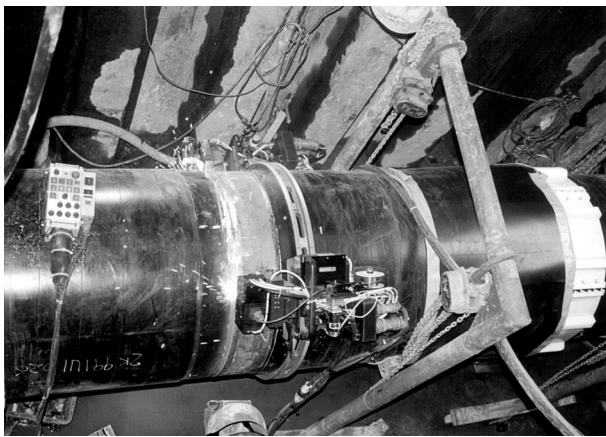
自動溶接施工（開削工法／一般埋設部）
